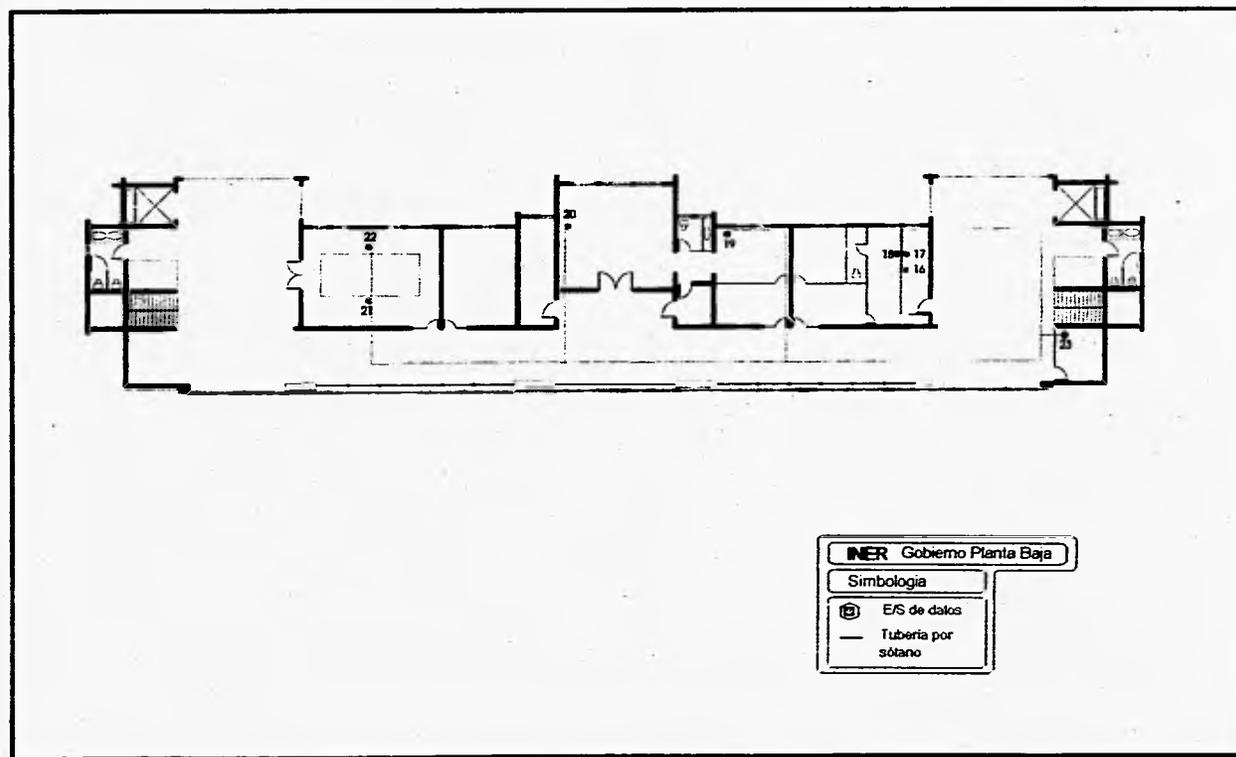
Cableado del Edificio de Gobierno Planta Baja
